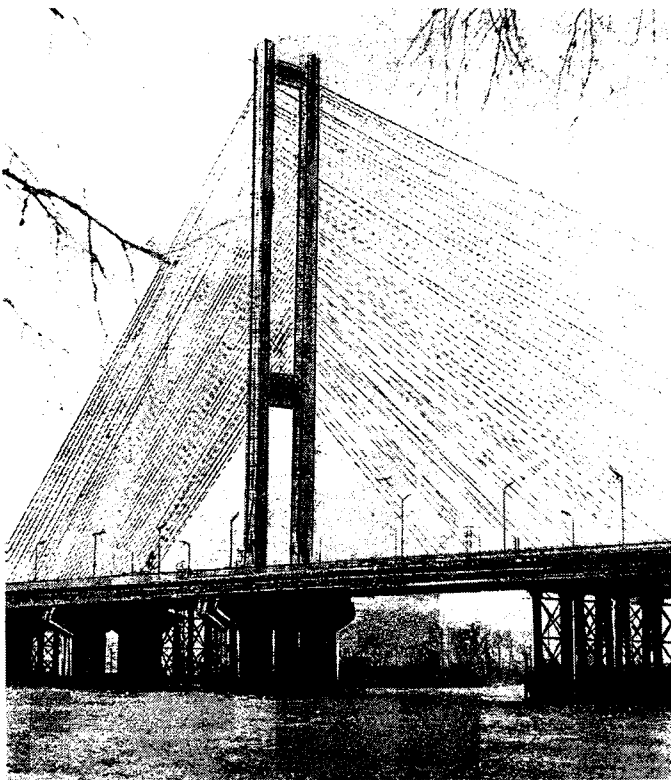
Фрагмент фасада моста с пилоном (на стадии строительства)
